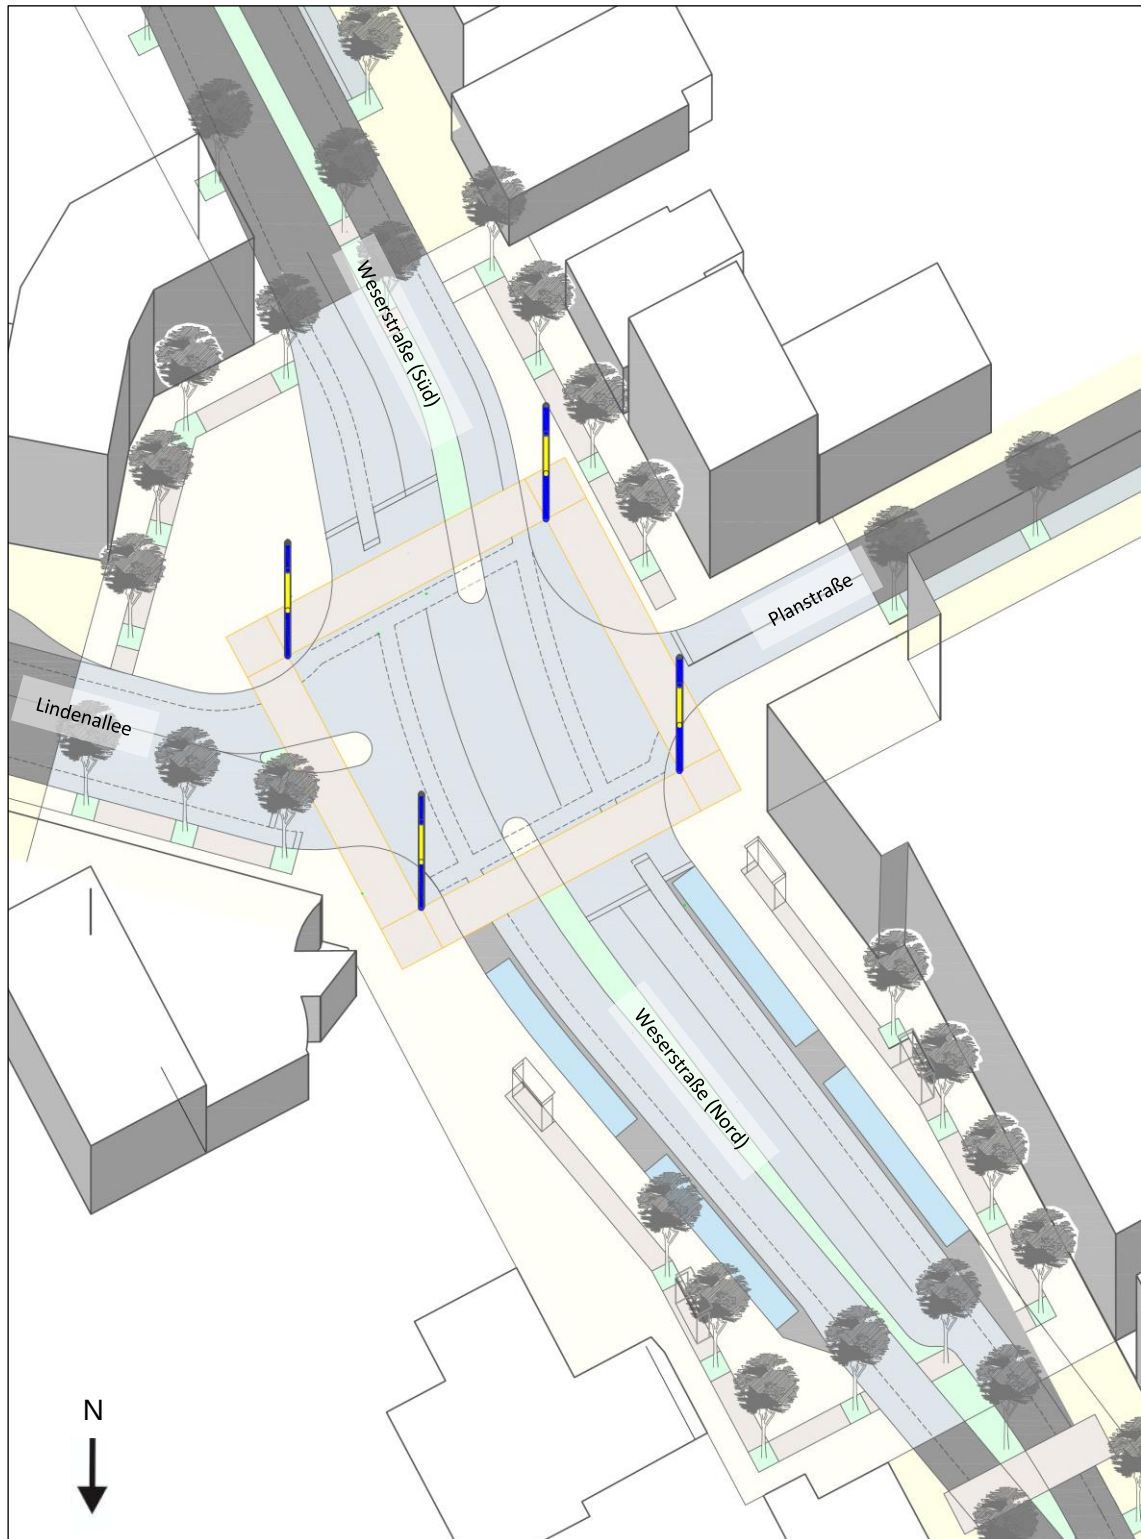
Entwurf Knotenpunktumbau Weserstraße / Lindenallee / Planstraße (LSA-geregelt)
